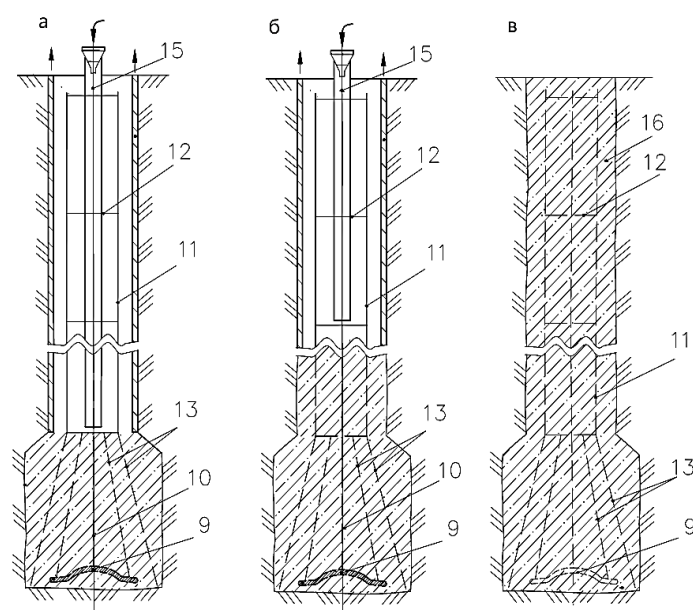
Схемы бетонирования свай с постепенным извлечением секций обсадной и бетонолитной труб (*а, б*) и готовой свай с уширением (*в*): 9 — опорная пластина; 10 — арматурный каркас; 11 — продольные арматурные стержни; 12 — поперечные арматурные стержни (хомуты); 13 — дополнительные арматурные стержни в уширяемой зоне; 15 — бетонолитная труба; 16 — готовая свая
